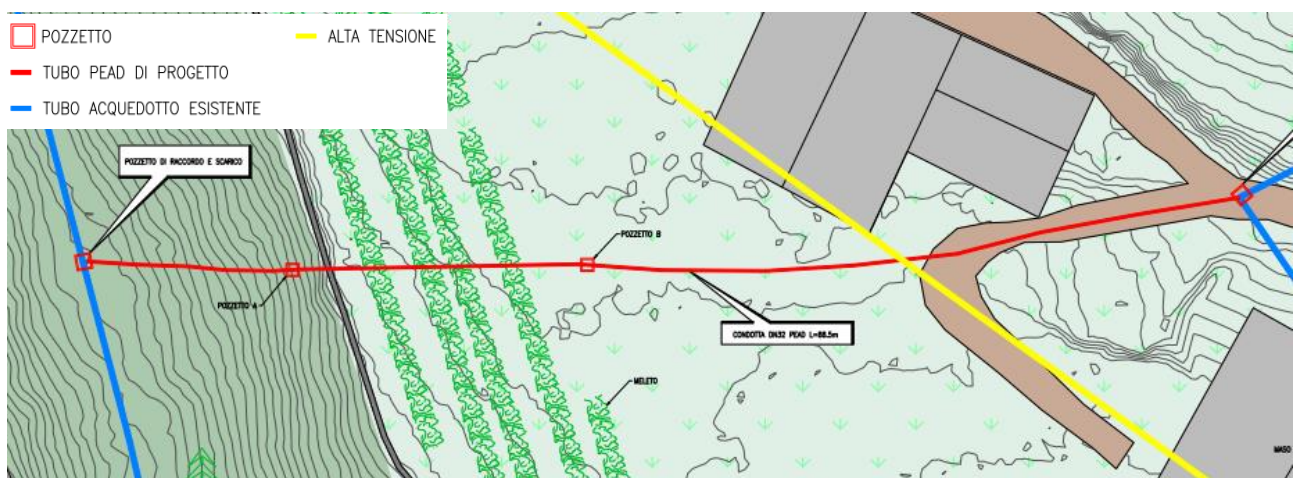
Estratto planimetria sottoservizi sorgente S5A
